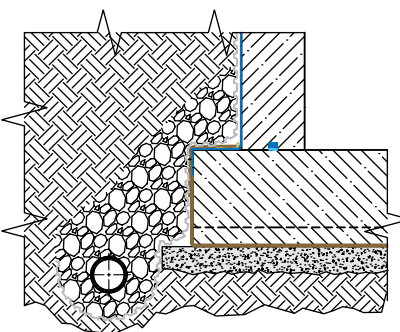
Узел – гидроизоляция фундамента при новом строительстве (подробнее на стр. 295)
